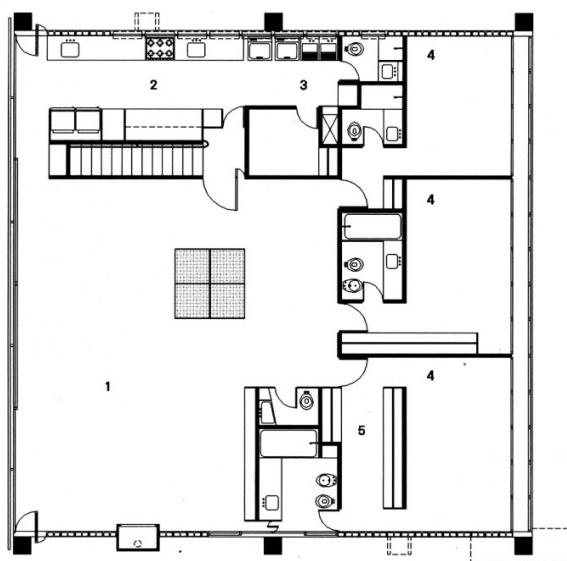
Planta do Pavimento Superior da Casa Gerassi
